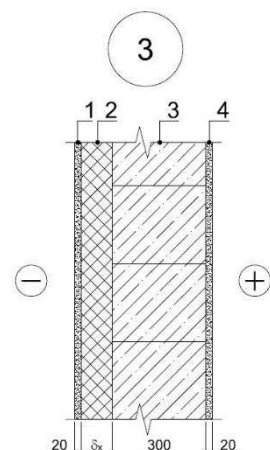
Вариант 3 конструкции наружной стены
